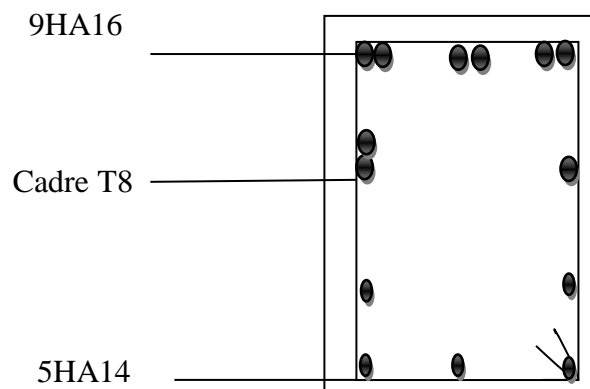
Ferraillage de la Poutre principale (35x40)
